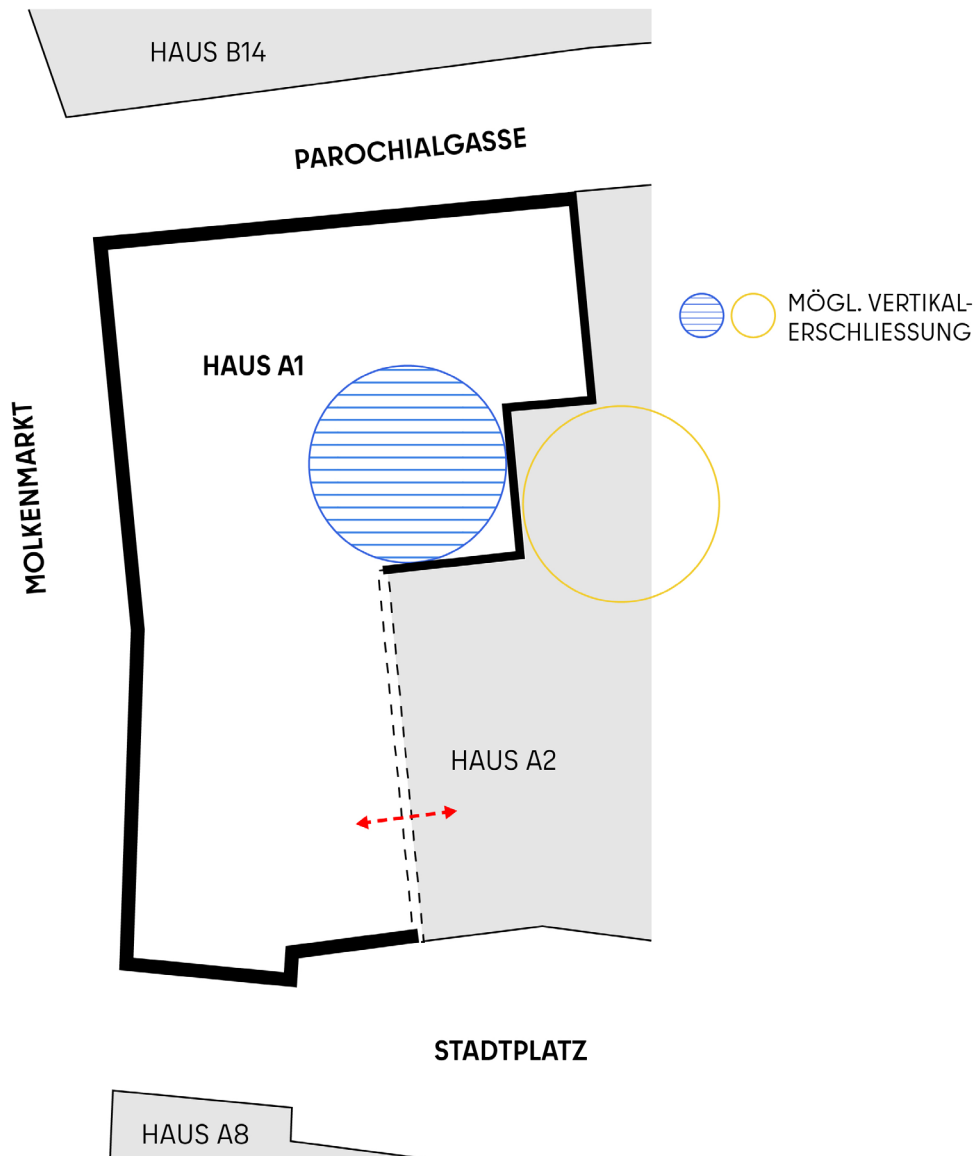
Schematischer Grundriss Untergeschoss
